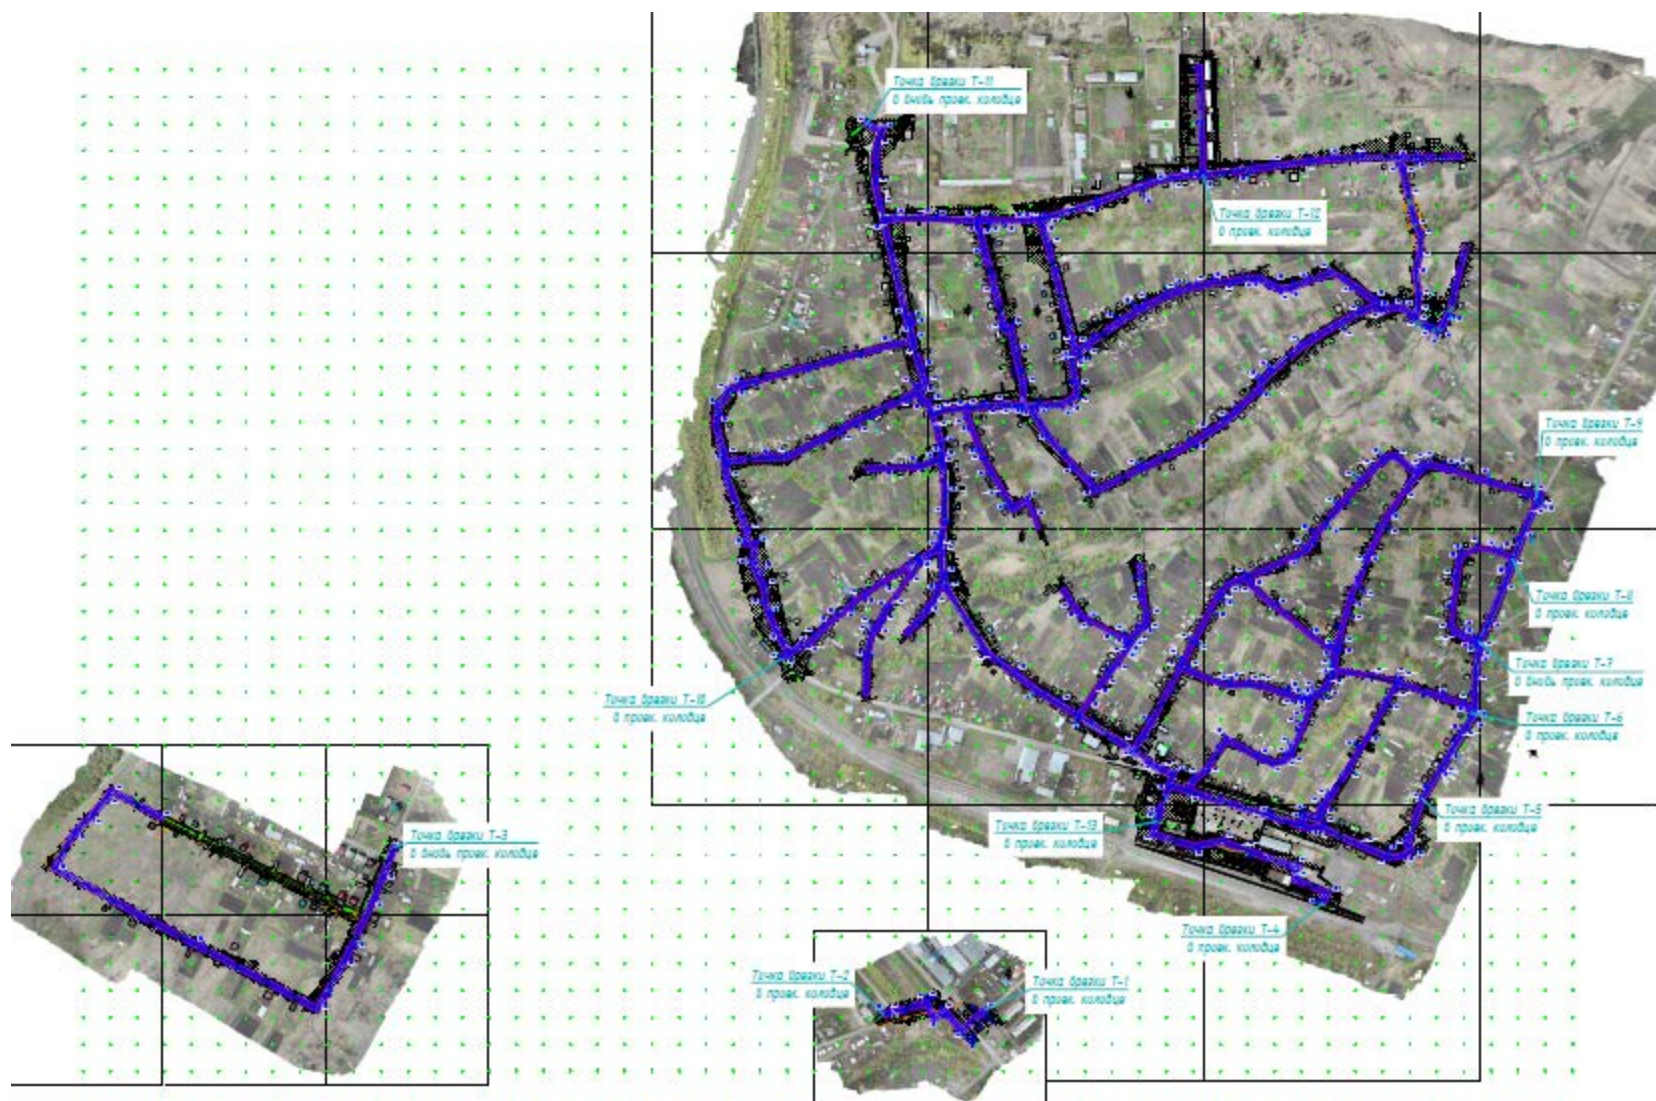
Строительство наружных сетей водопровода в п. Плотниково Промышленновского муниципального района
